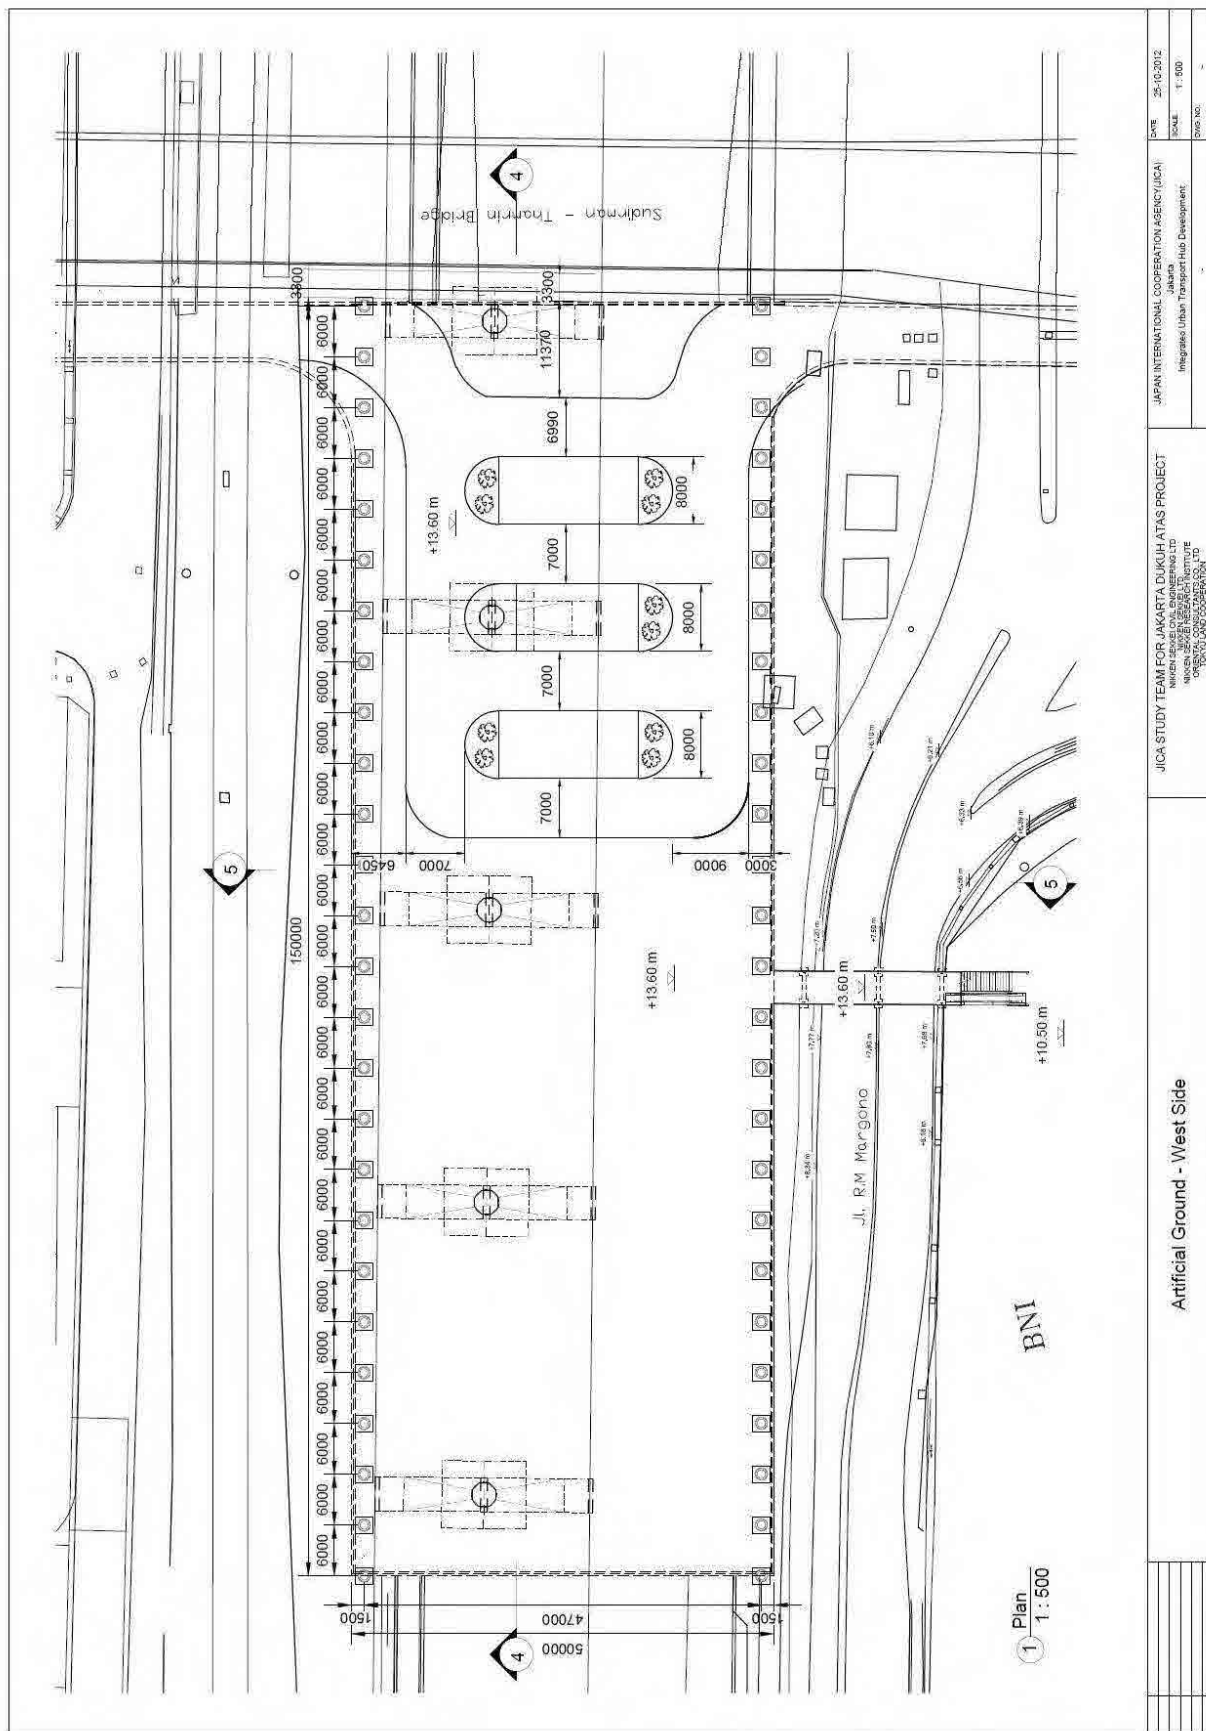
西側人工地盤平面図 (出典：調査団)
